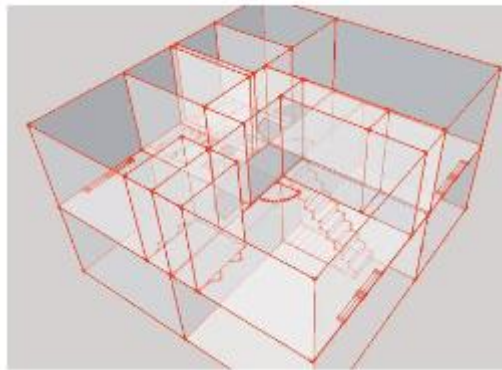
Dorong/Tarik Tangga Ke Lebar Yang Seajar Dengan Denah
